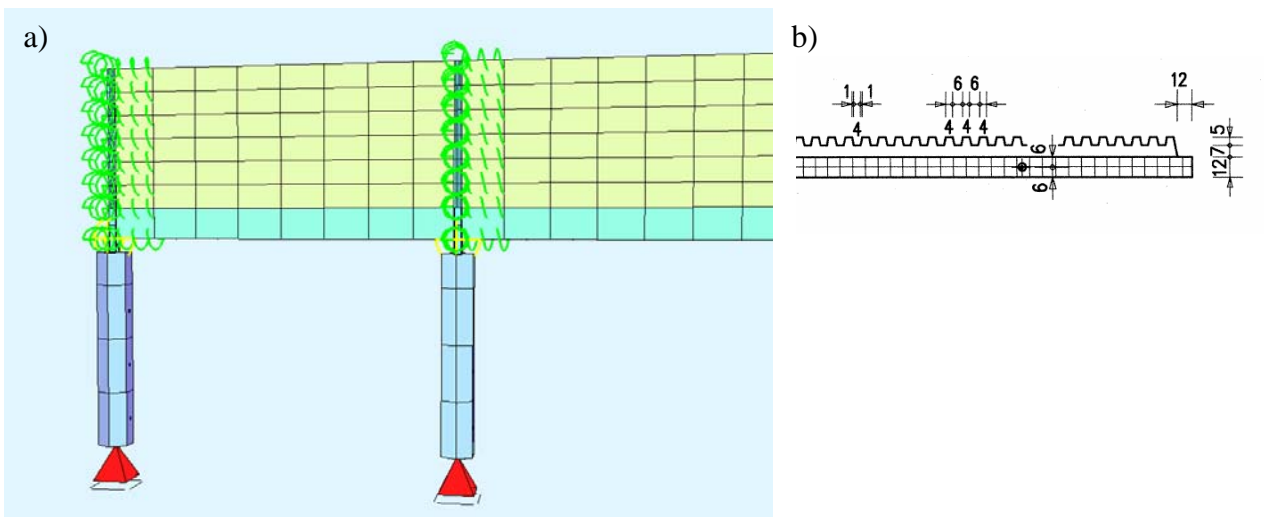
FE-Modell der Betonschutzwände, Betonelement mit Trag- und Absorptionsschicht
